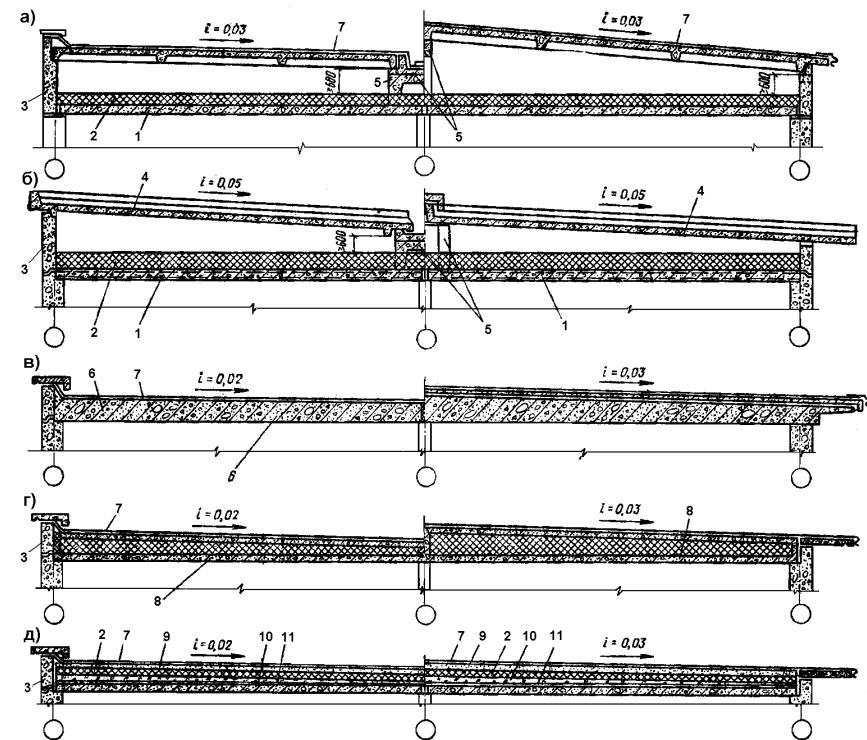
Принципиальные схемы конструкций бесчертанных железобетонных крыши.
